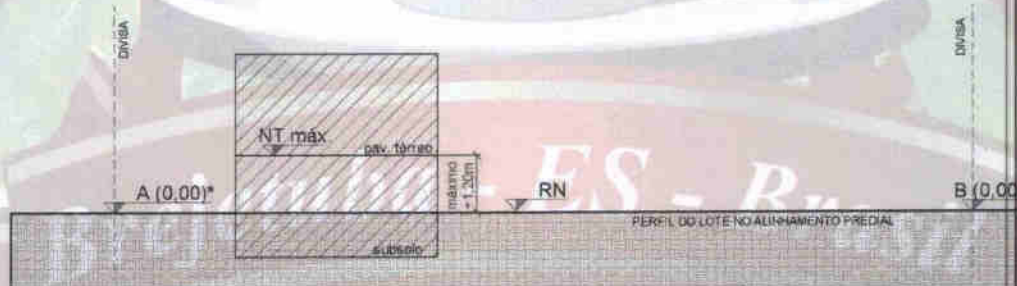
B: Corte ilustrativo transversal da definição da RN e NT em terreno plano na testada (sem escala)
